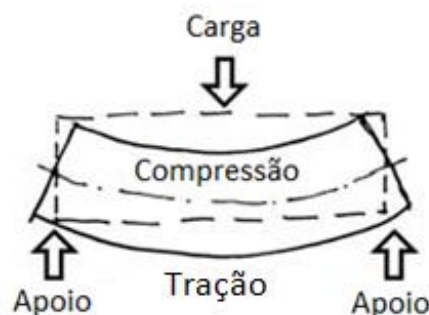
Esquema da flexão de uma laje [adaptado de W15]
